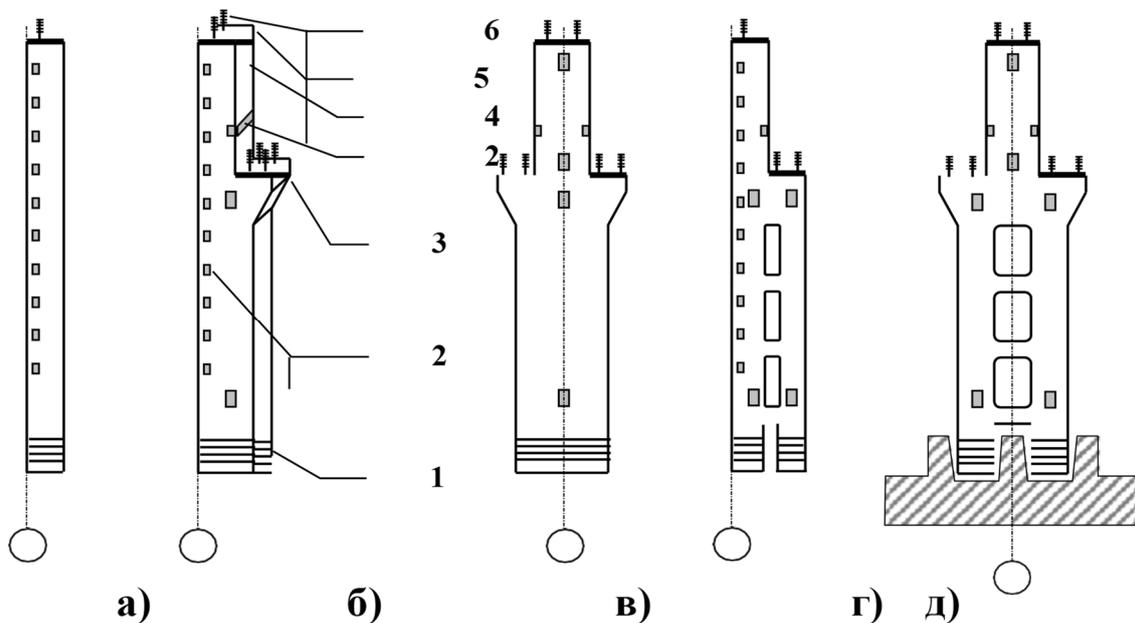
Збірні залізобетонні колони одноповерхових будівель:
